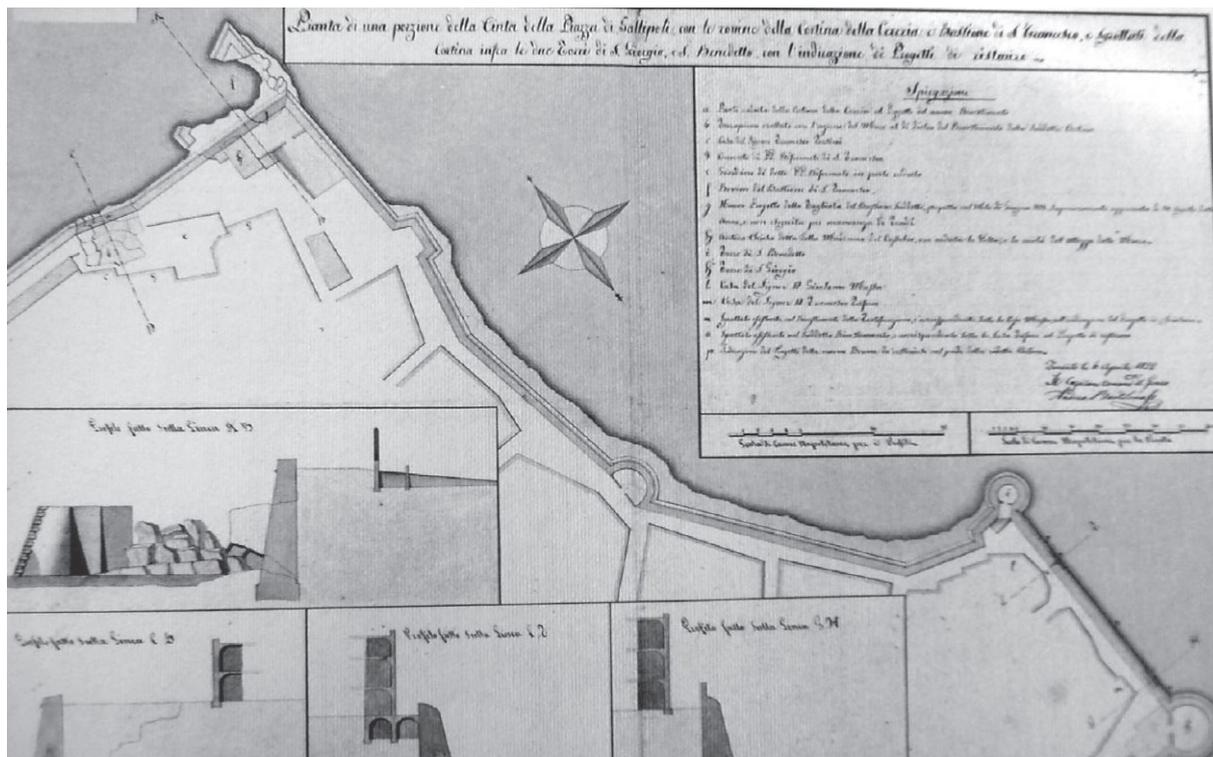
Pianta di una porzione della cinta della piazza di Gallipoli [1822].
